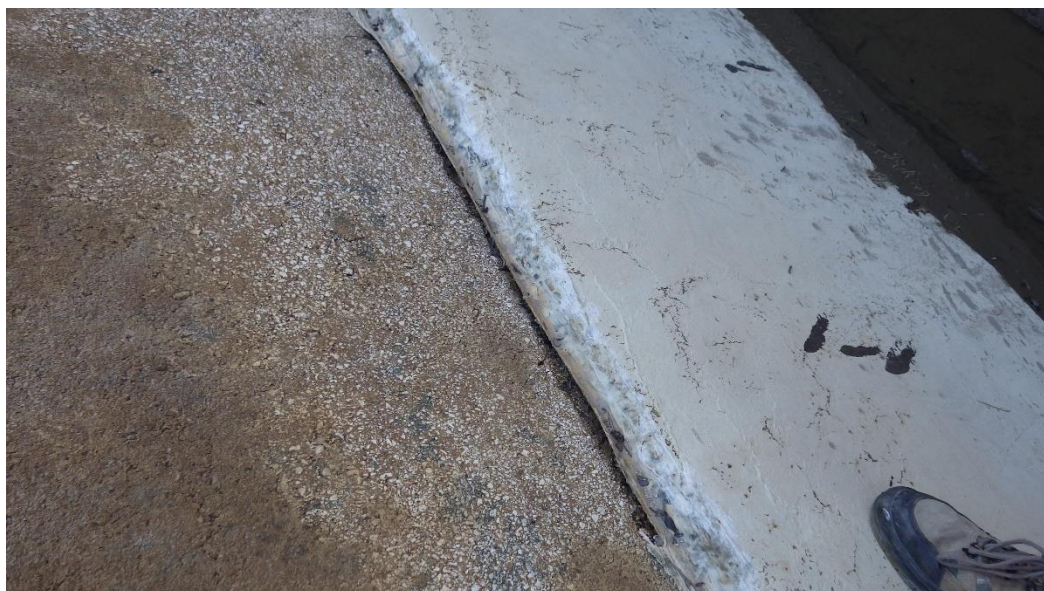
Défaut n°28 – Décollement au niveau de la plinthe sur la bande n°10 (90cm de long)
